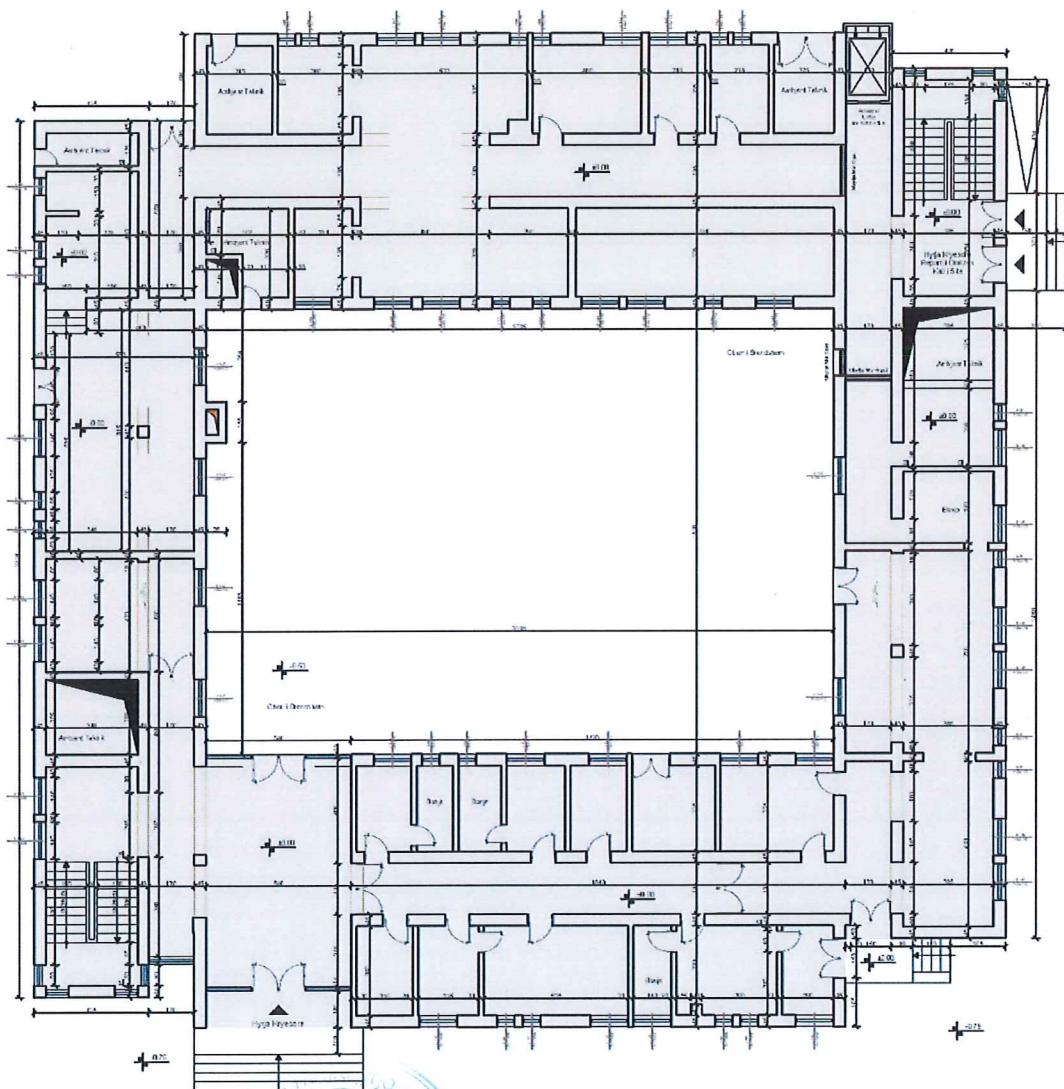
Planimetria e Katit Perdhe (gjendja ekzistuese)
